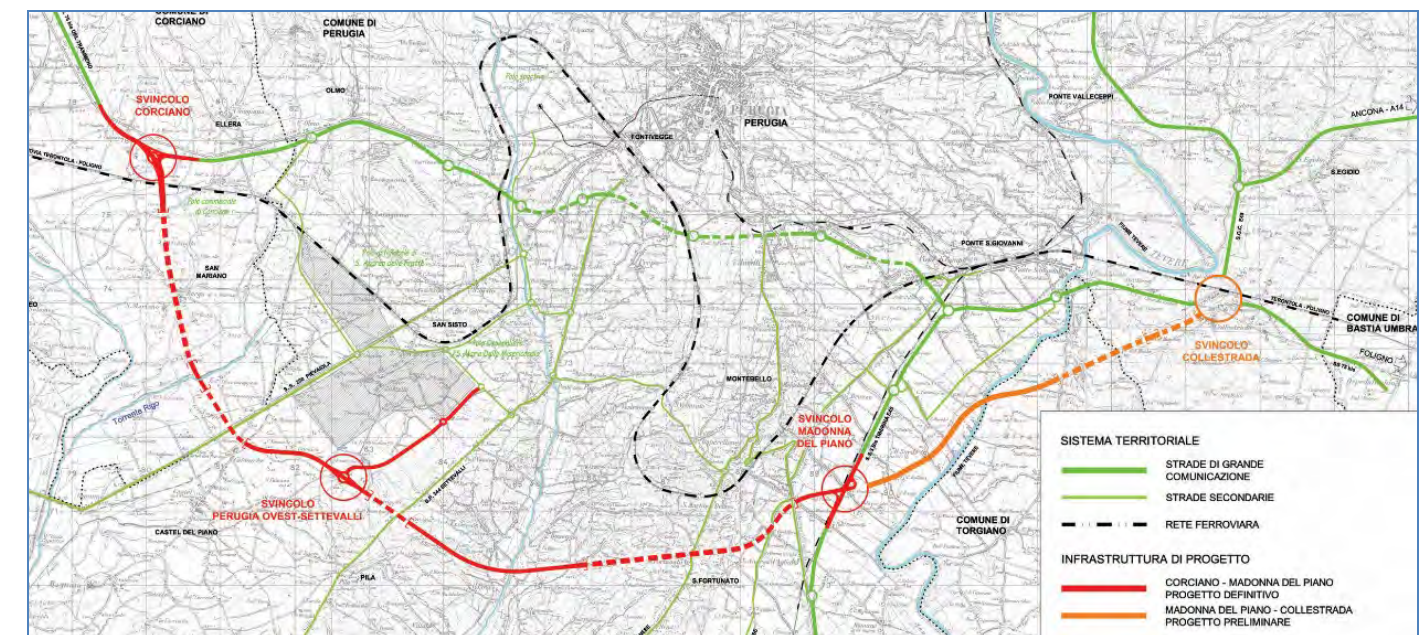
Progetto Preliminare: planimetria generale con individuazione delle tratte del Nodo di Perugia
